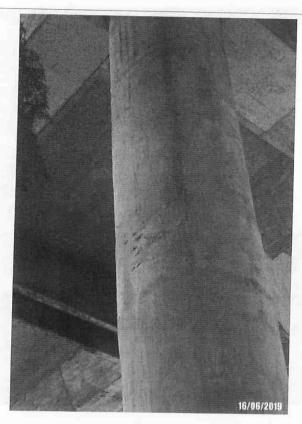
Detalhe de pilares com pequenas fissuras e pontos de desplacamento de concreto.
